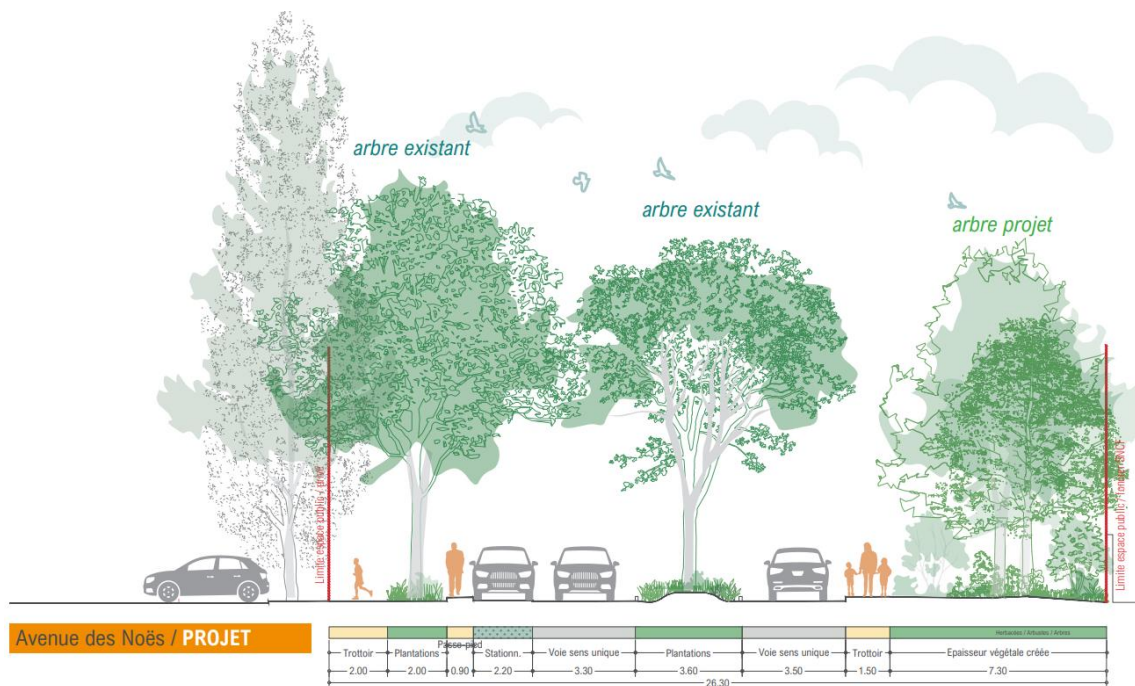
Plan de coupe de l'Avenue des Noës après projet (La Fabrique Urbaine, 2025)
